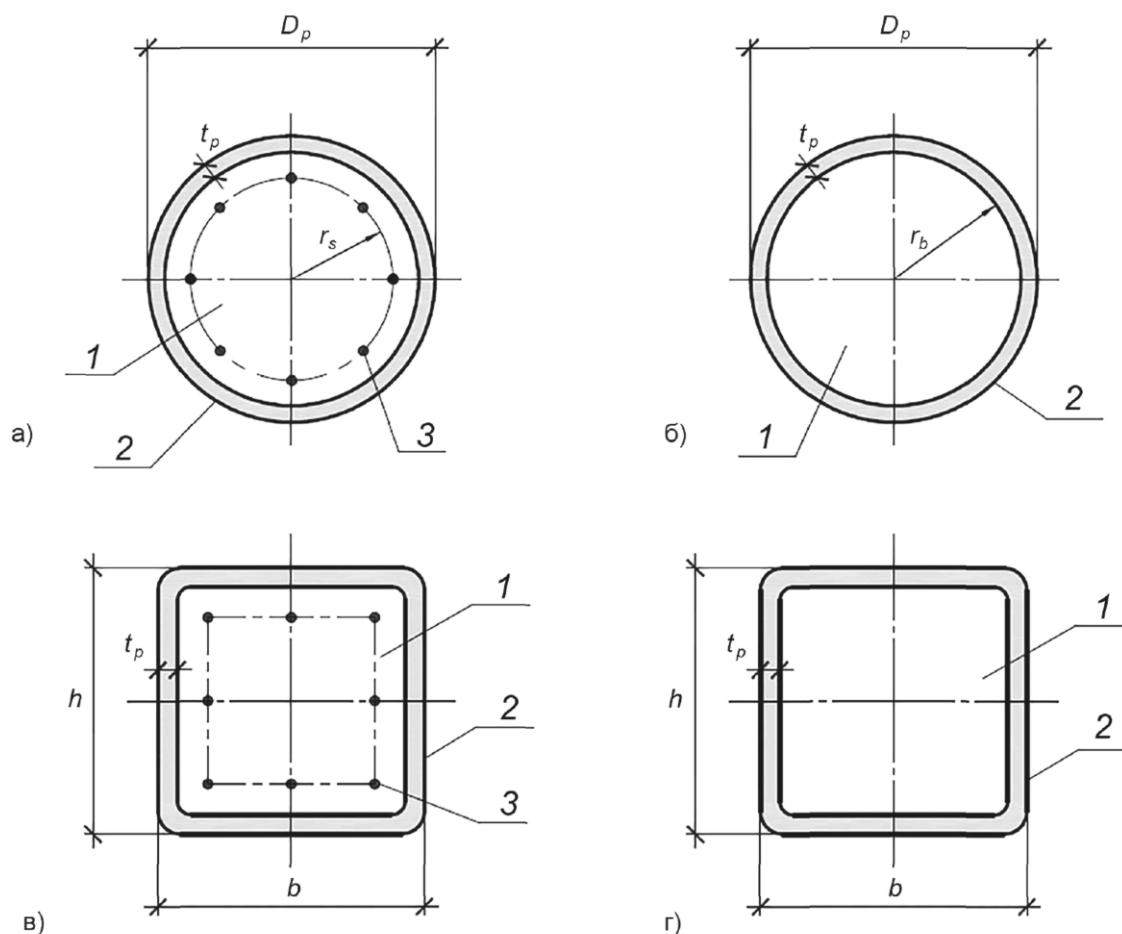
Типовые поперечные сечения железобетонных конструкций с жесткой арматурой
